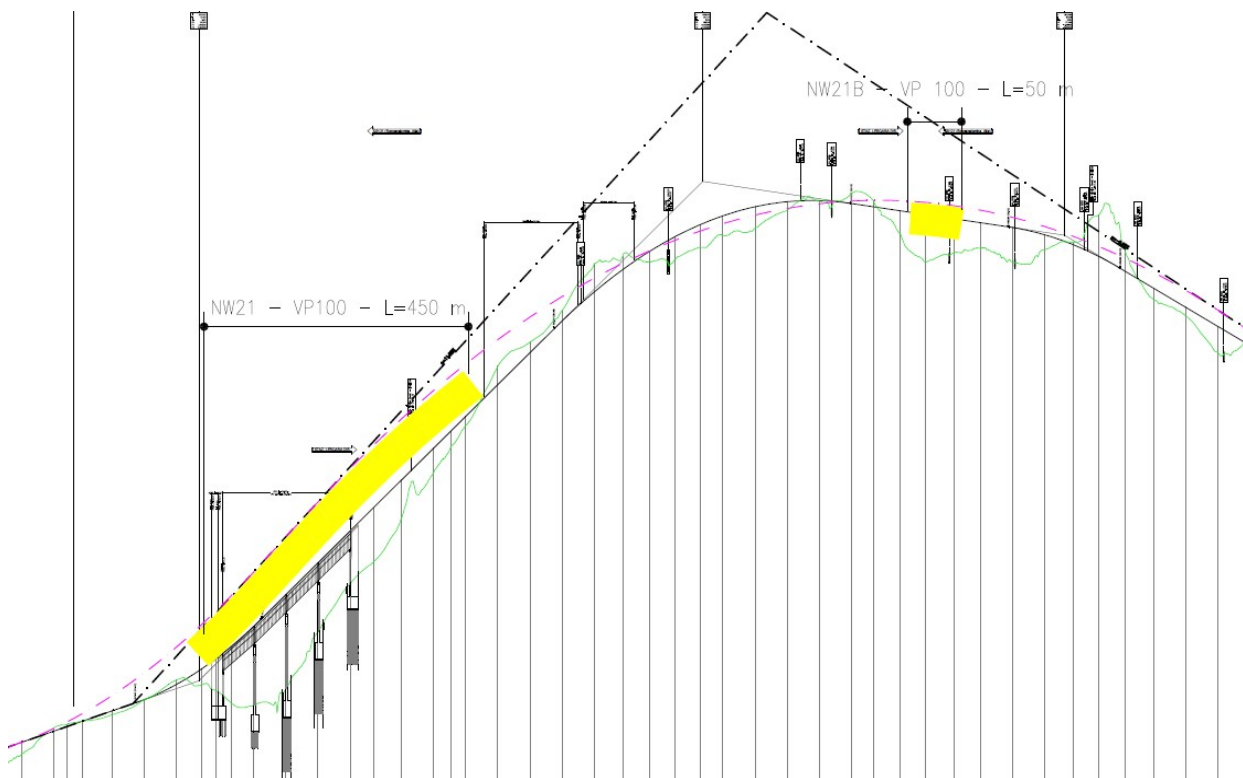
Planimetria di progetto dalla Km 4+300 alla Km 5+145, frana “F”
